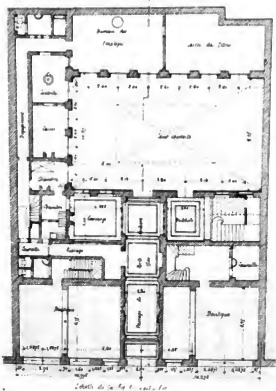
Plan du Rez de Chaussée. 1000 p.m.
